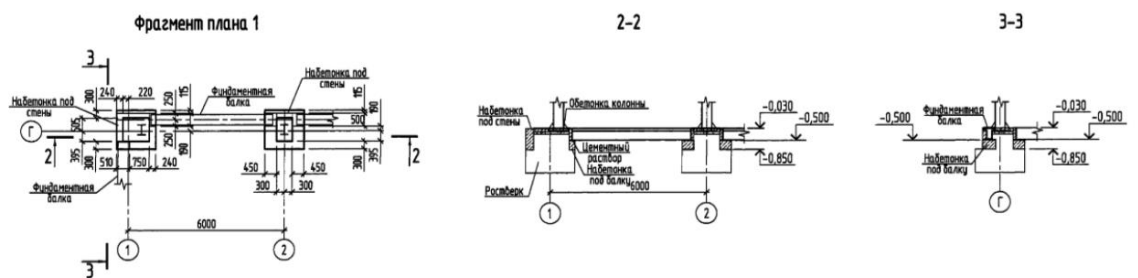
Фрагмент плана и разрез столбчатого фундамента РСм1 и РСм3
